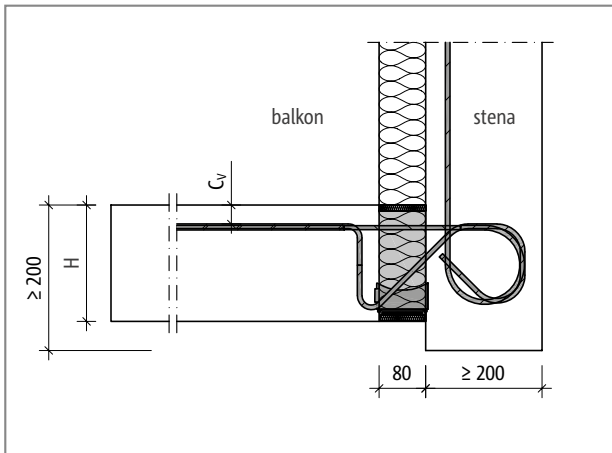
Schöck Isokorb® T tip KL-HV: nižje ležeči balkon in zunanja izolacija
